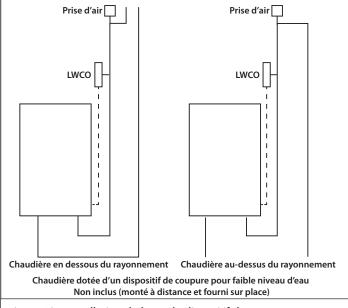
Installation de base du dispositif de coupure pour faible niveau d'eau
